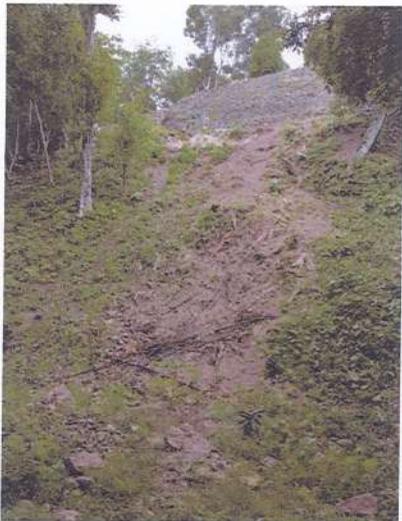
Edificio B-24, fachada norte, área afectada por el deslizamiento de material constructivo.
